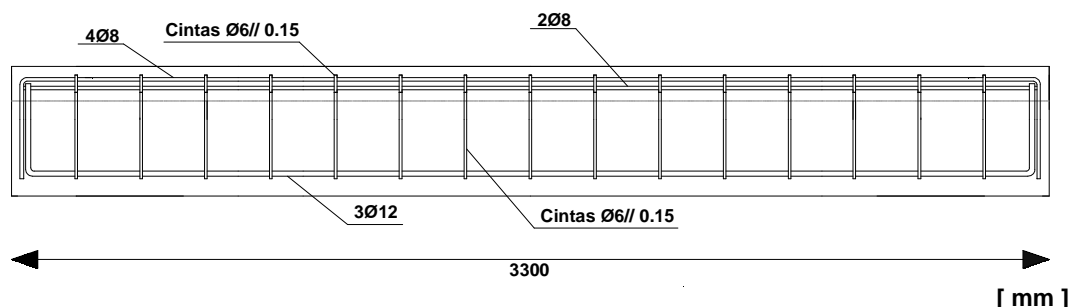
Pormenorização longitudinal das vigas em estudo
